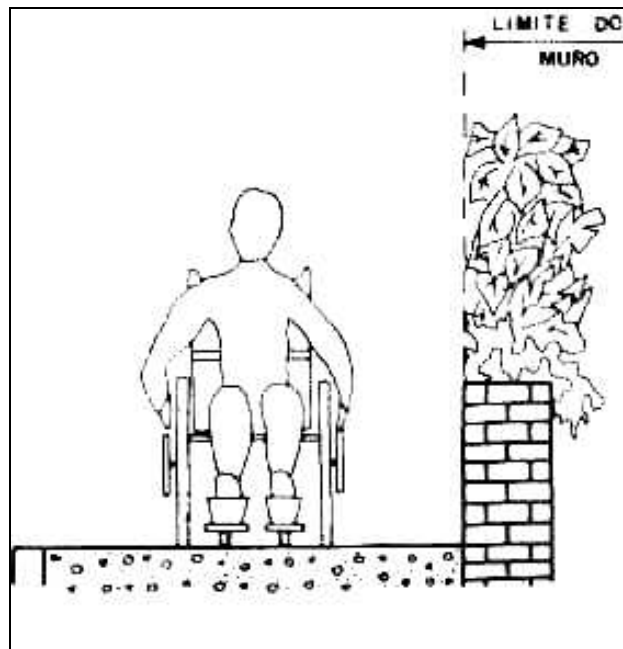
Norma técnica para a construção de canteiros em calçadas (Fonte: ABNT, 1985)
